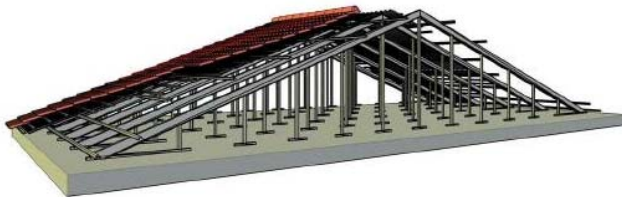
Detalle armadura de cubierta propuesta para la intervención.
